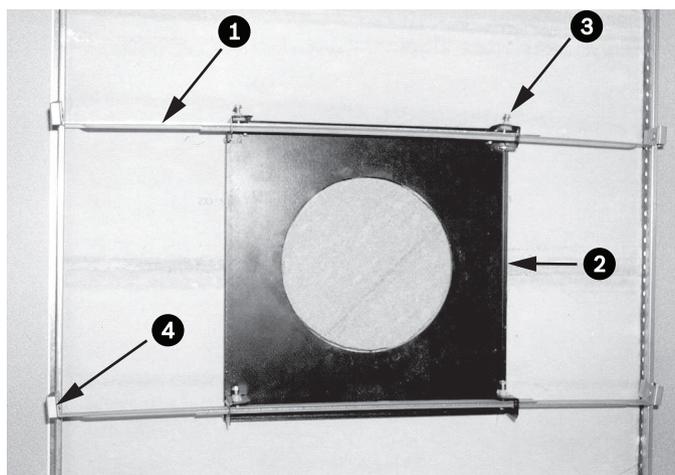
Staffa per soffitto di sospensione (vista dall'alto)
